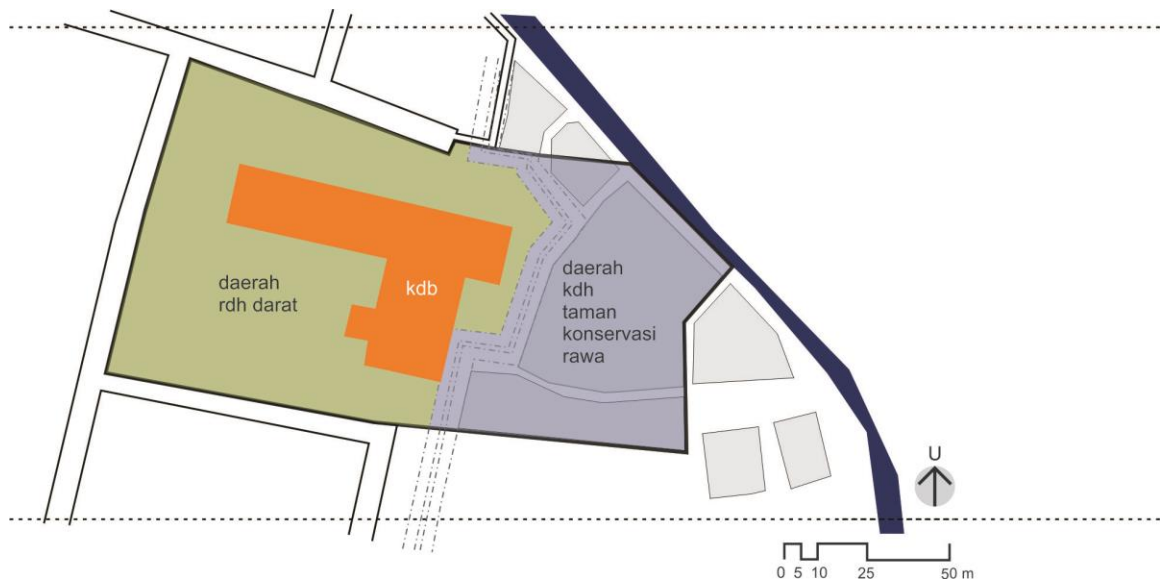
18 Penempatan struktur bangunan pada bagian darat site
